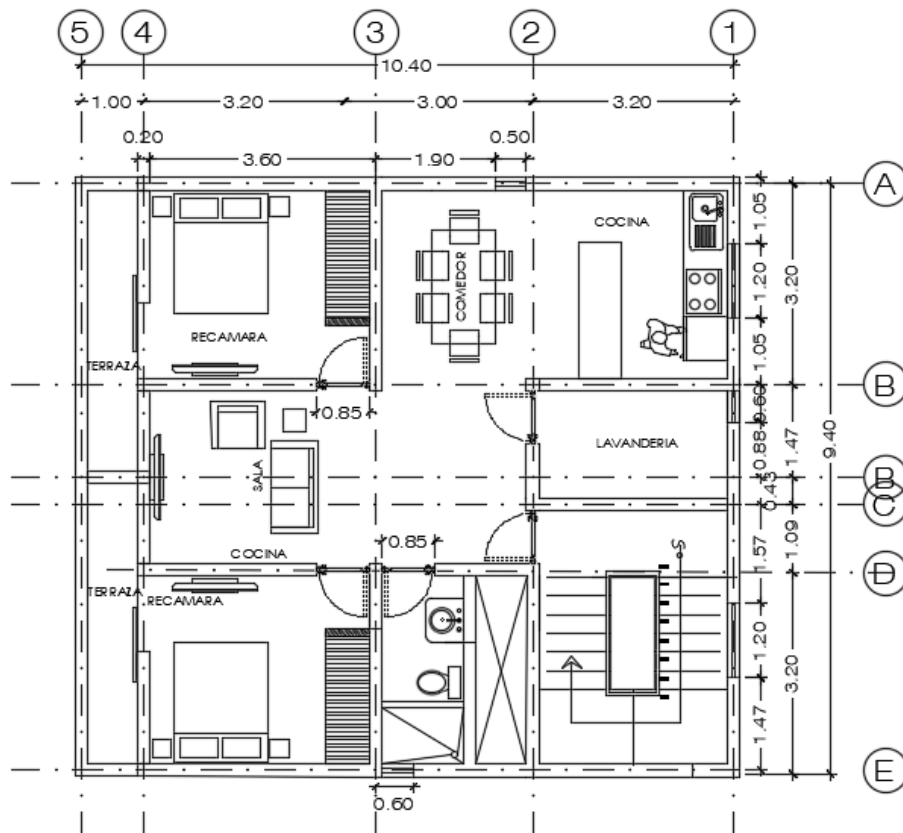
Planta Arquitectónica de los 5 niveles. Ramírez,2022.
